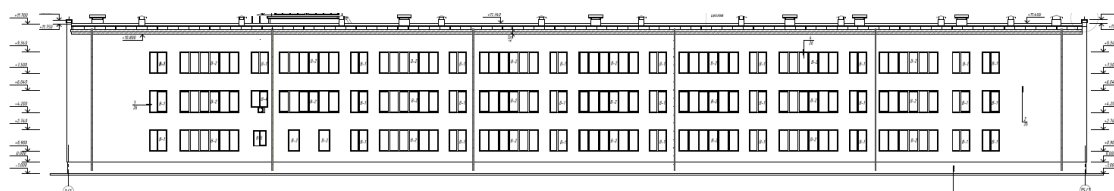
Встановлений фасад будівлі (за результатами проведених обмірів фасадів будівлі).
